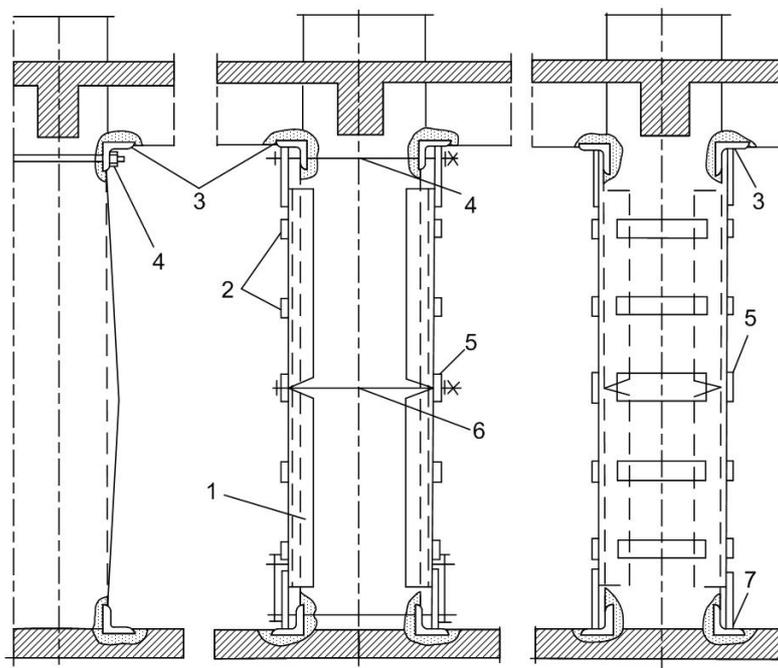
Усиление преднапряженными распорками: 1 – распорка; 2 – соединительные планки; 3 – верхний опорный уголок; 4 – монтажная шпилька; 5 – центральная планка; 6 – стяжной болт; 7 – нижний опорный уголок
